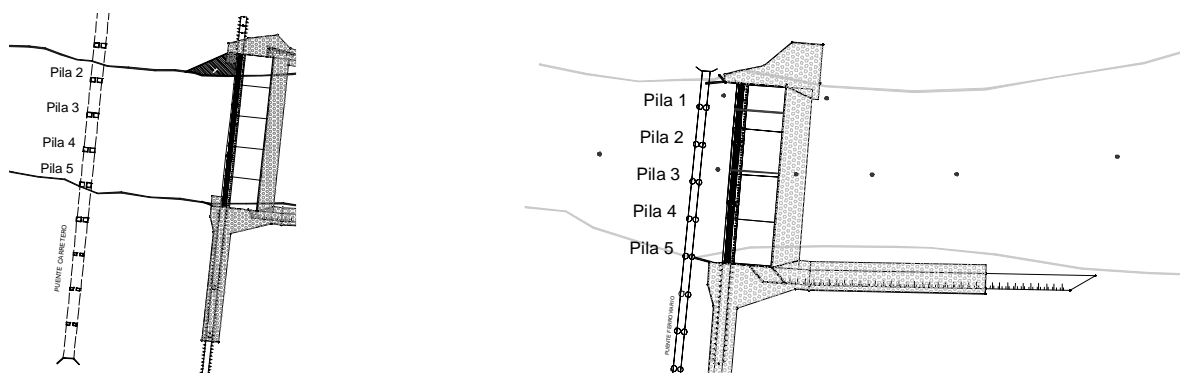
Ubicación de las pilas relevadas en los Puentes Carretero y Ferroviario.
